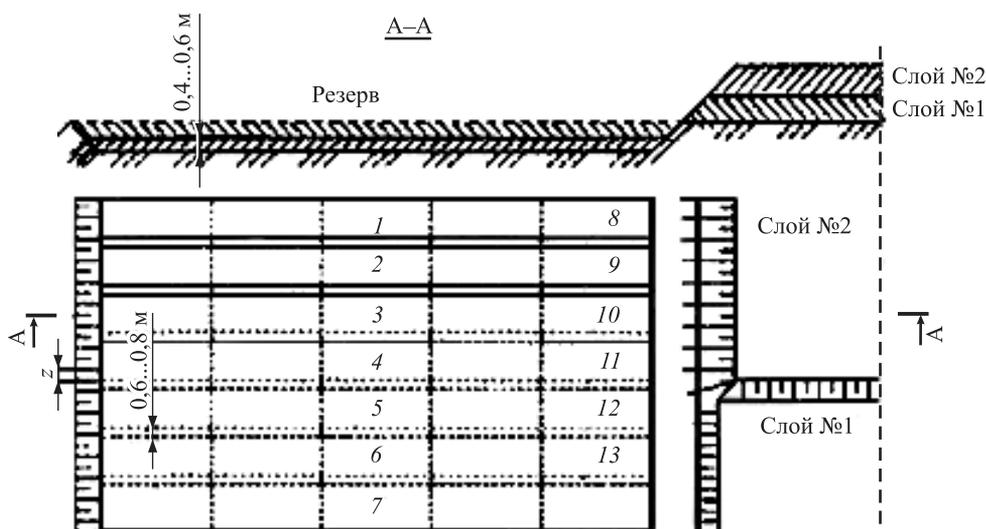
Способ траншейной разработки резерва: 1...7 – траншеи; 8...13 – стенки-гребни;  $z$  – ширина перекрытия следа (0,2...0,3 м)
